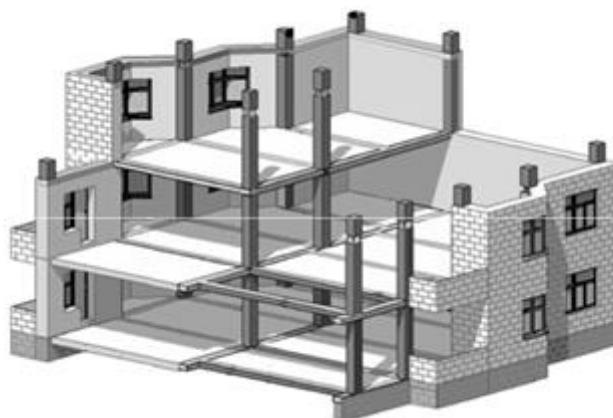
Конструктивна схема каркасно-монолітної будівлі
